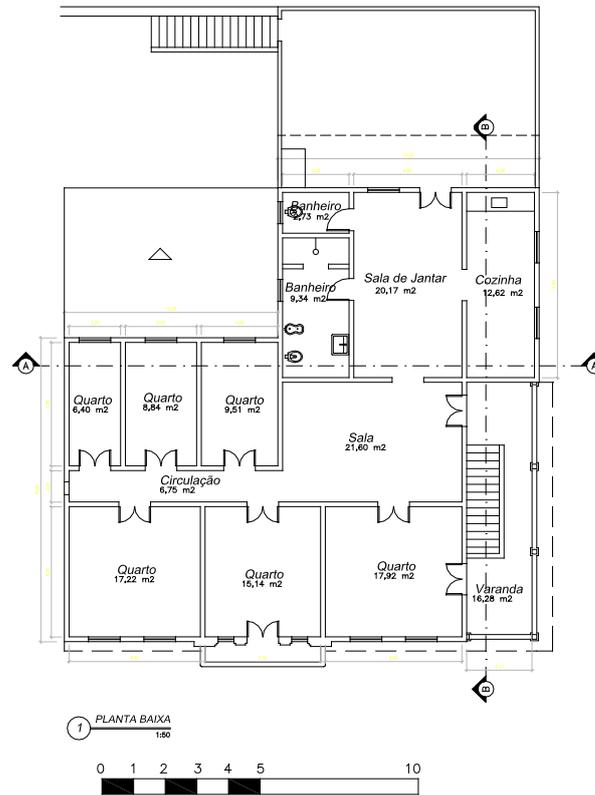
Planta pavimento superior - Casa Anna Acha Ayub
